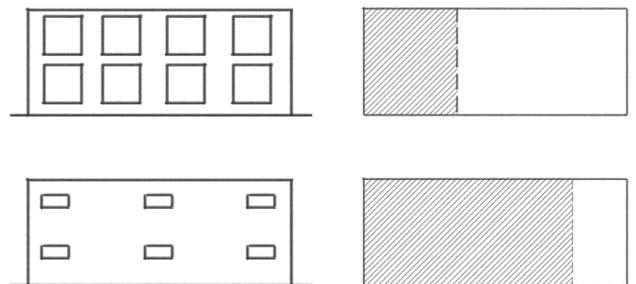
Porcentaje de vanos en fachada. Elaboración propia.
